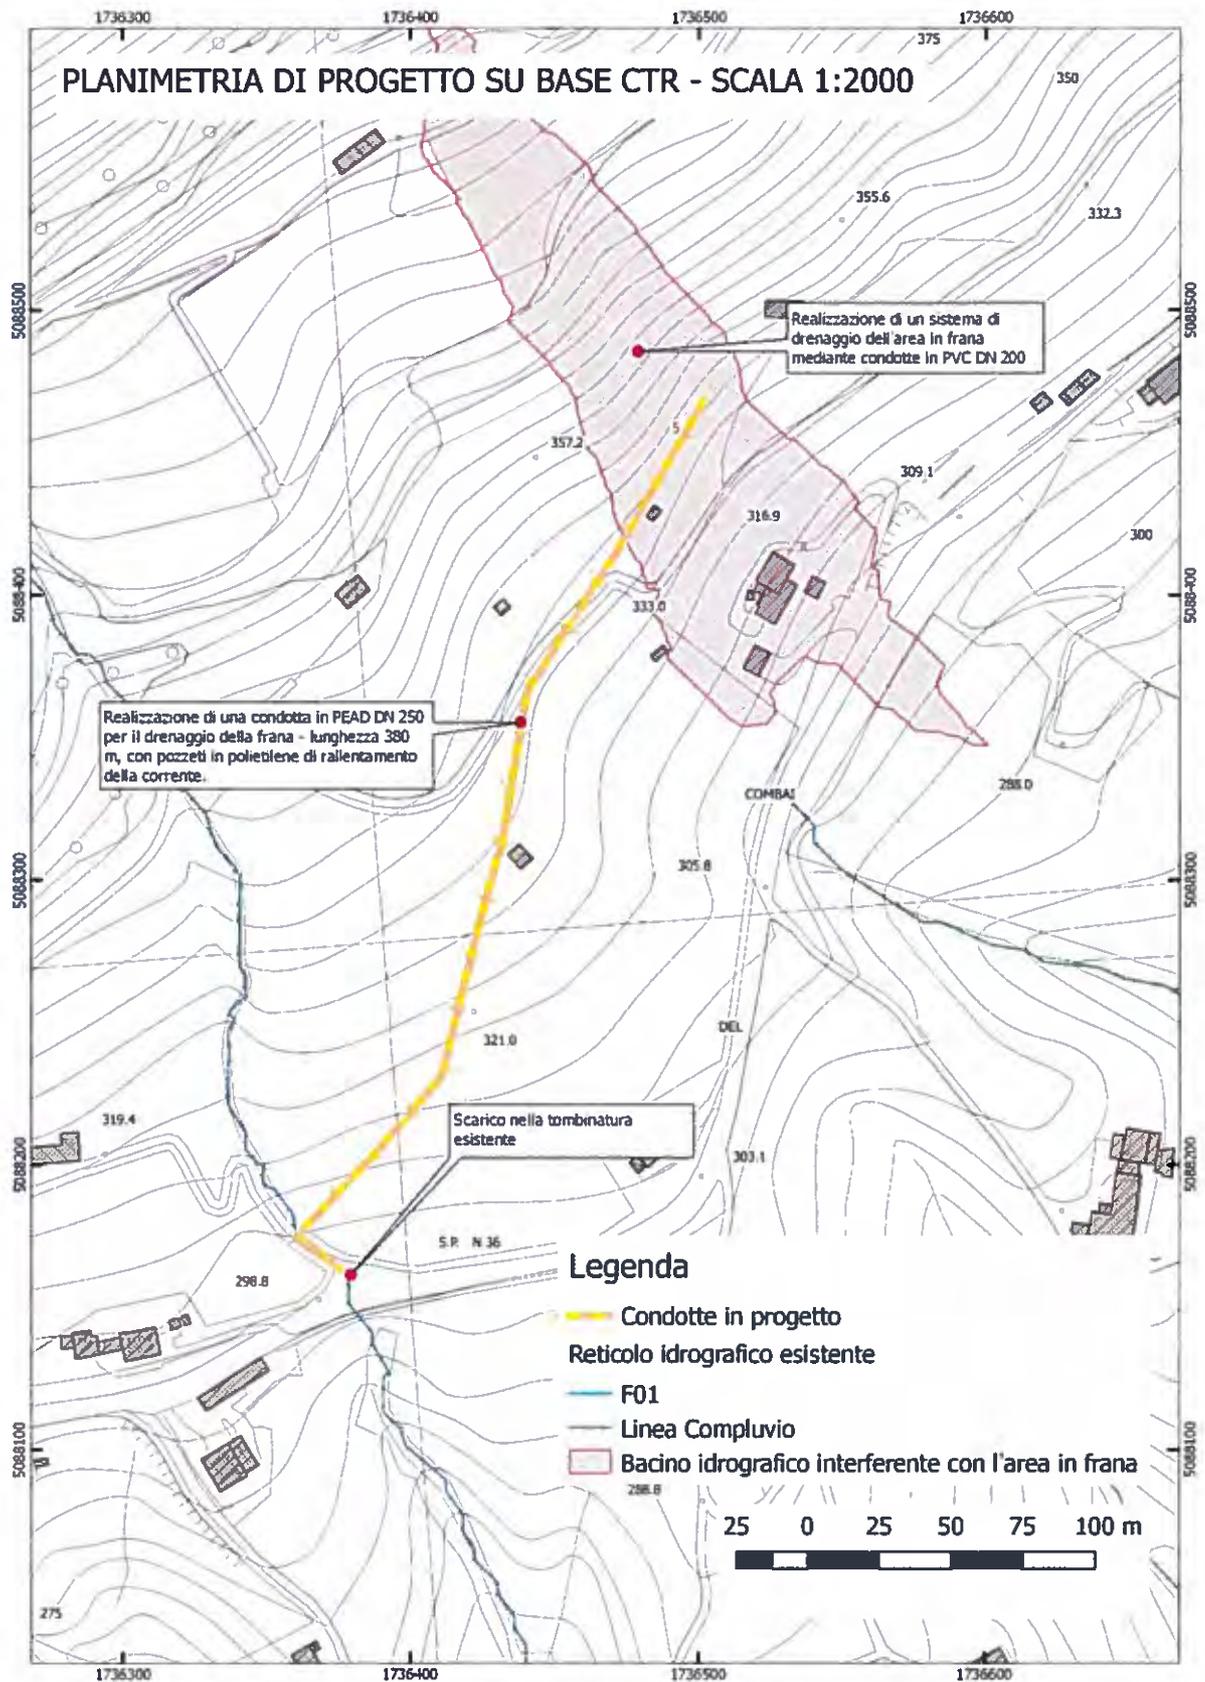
Intervento n.4 – Sistemazione della frana a Santo Stefano - Planimetria di progetto
